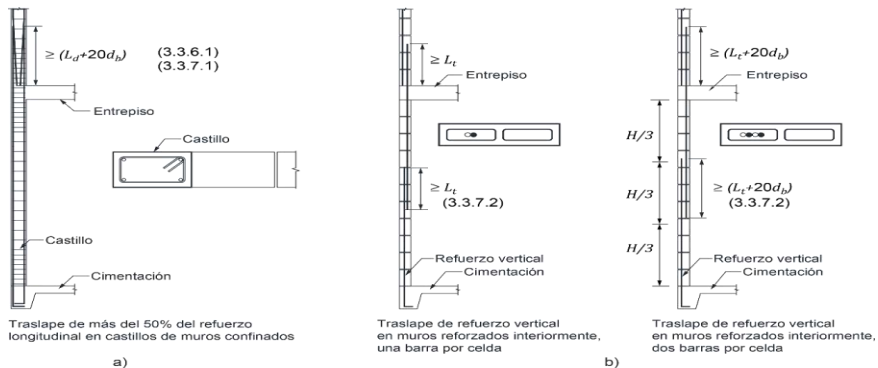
Longitudes de traslape de barras, a) en castillos de muros confinados y b) en muros reforzados interiormente
